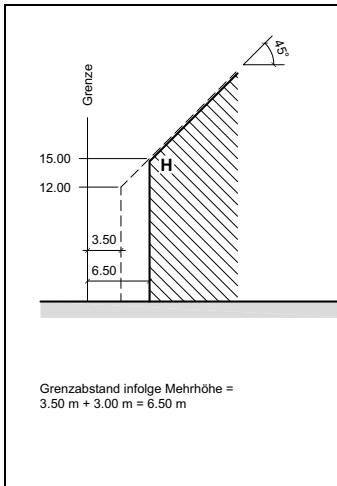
Grenzabstand eines komplizierten Baukörpers
